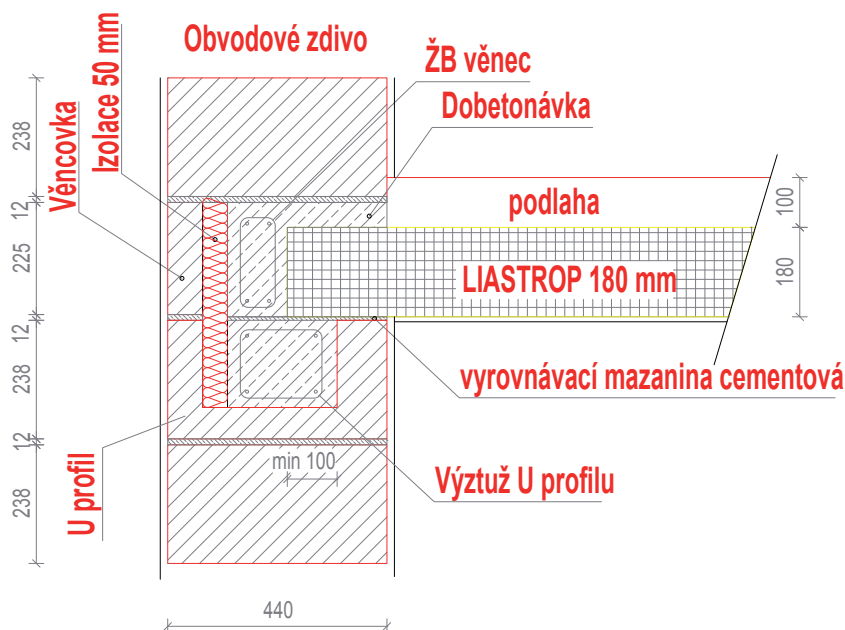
Uložení stropních dílců tl. 150 mm na obvodovou stěnu na železobetonový věnec s U profilem
